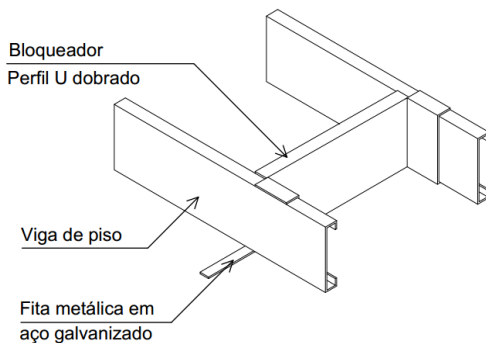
Bloqueadores em perfis U e fitas em vigas de piso
